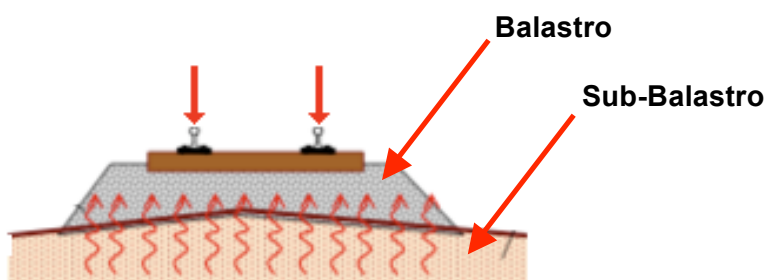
Camada de Sub-balastro [adaptado de Silva, 2004]
